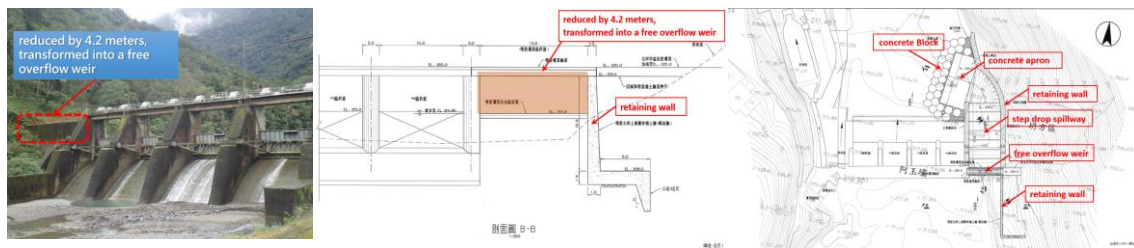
Ayu dam retrofitting work regarding emergency overflow facility.
